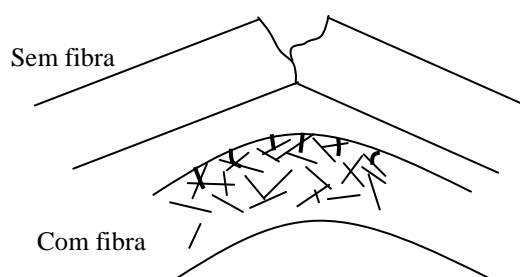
Processo de fissuração do concreto convencional e do concreto reforçado com fibras de aço.
